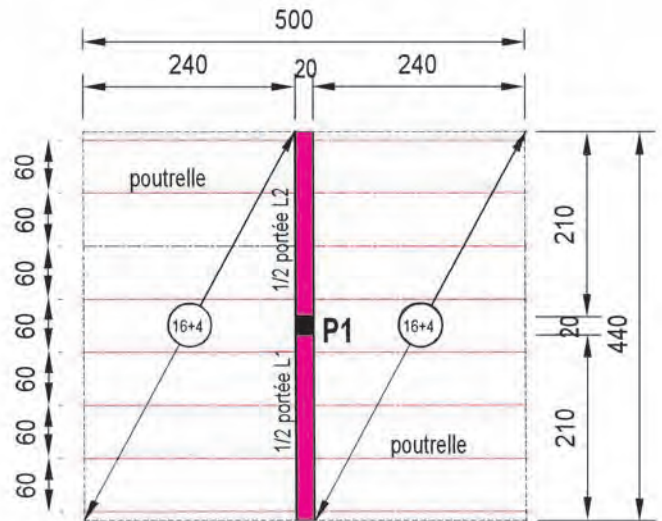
Vue de dessus du plancher, des poutres et des poutrelles
